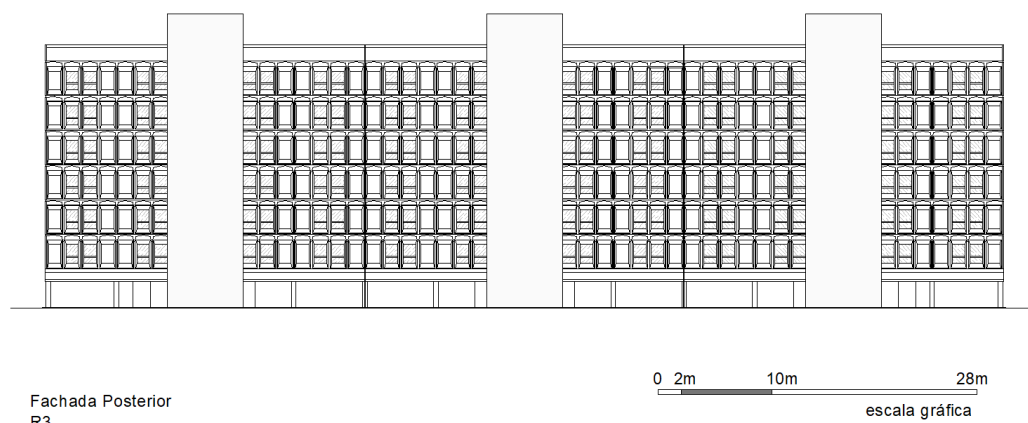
Fachada posterior do R3. Fonte: da autora, adaptado das pranchas originais do Acervo do Arquiteto Milton Ramos.
